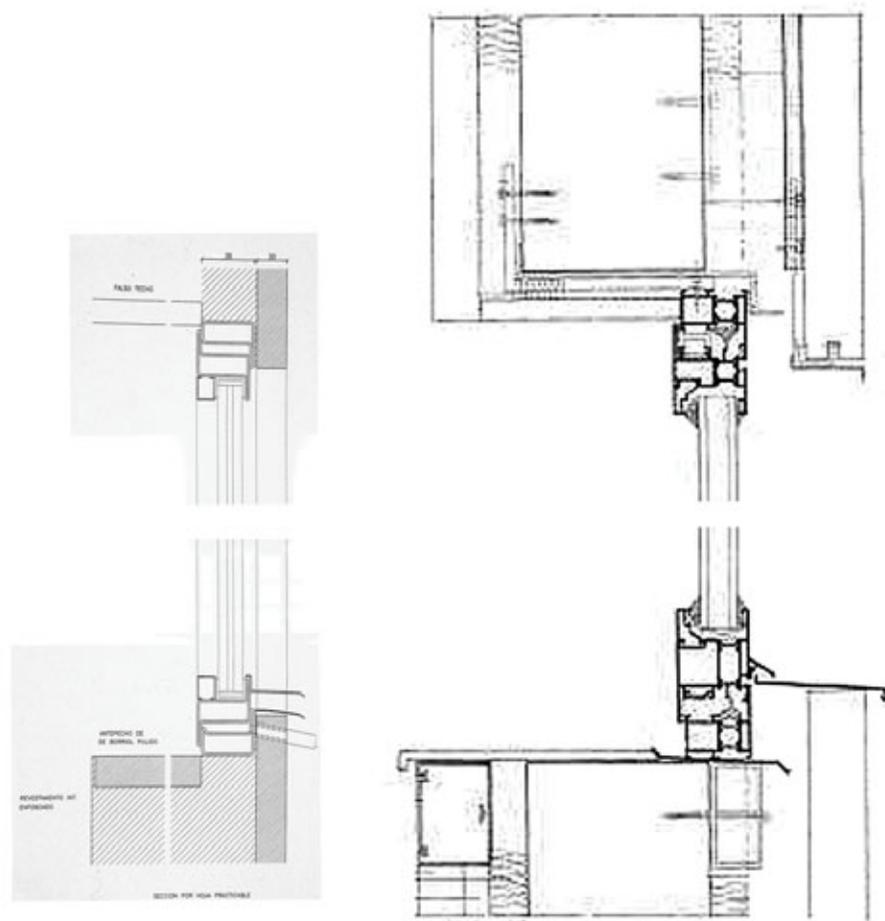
Detalle de encuentro de carpintería con cerramiento exterior en Gobierno Civil e Institutos de Investigación. Montaje Santiago Barge.
